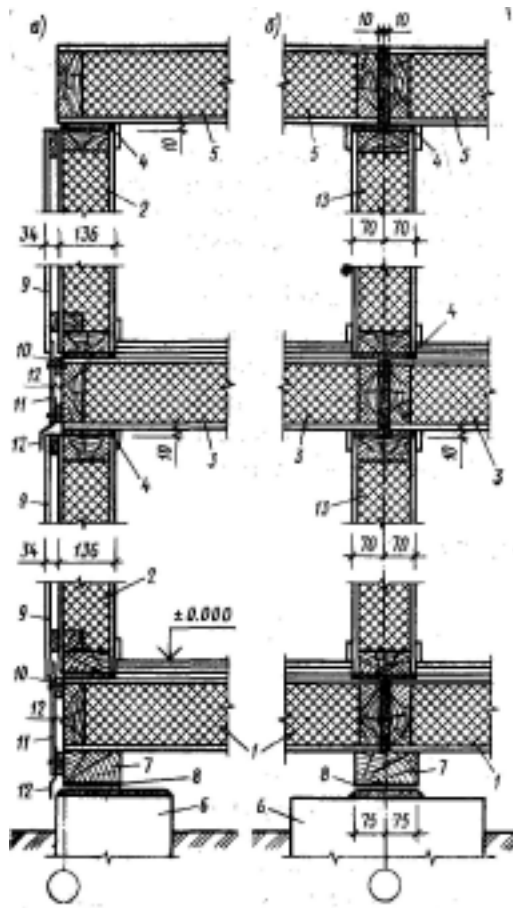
Конструкция горизонтального шва клефанерных панелей наружных и внутренних стен:
